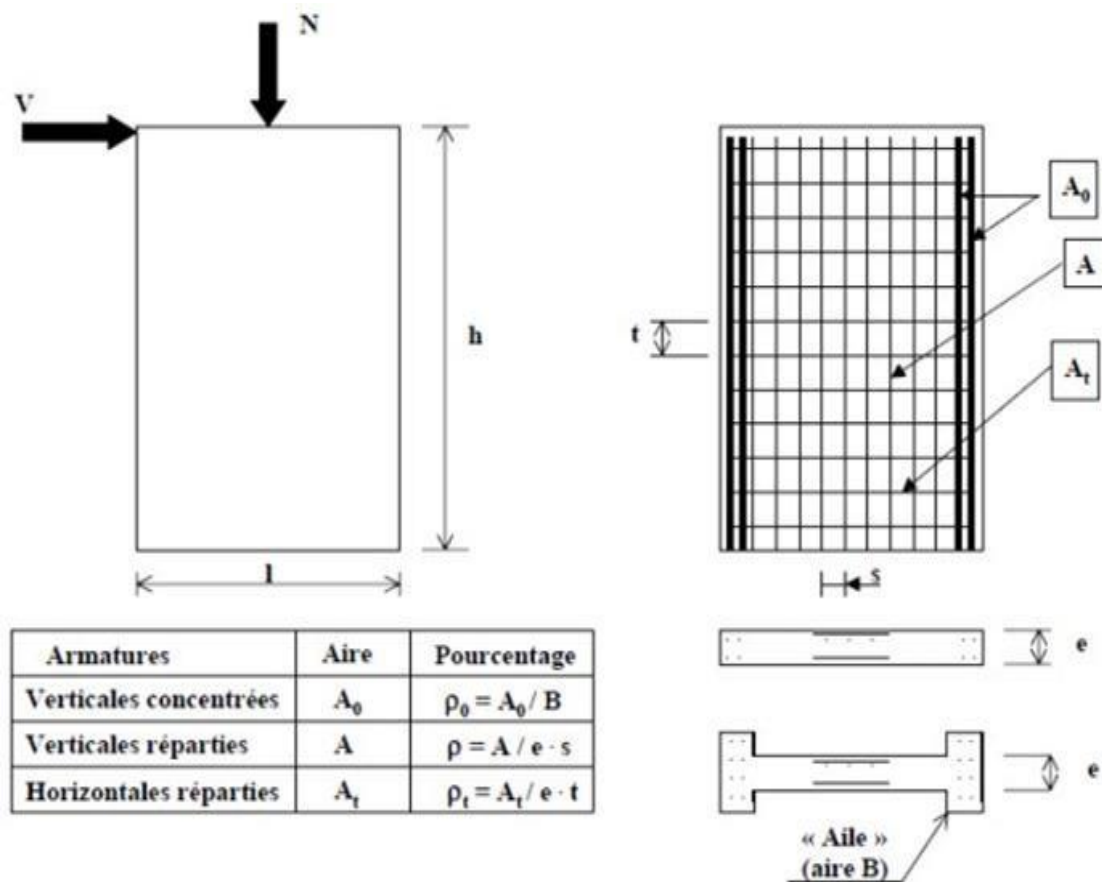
Schéma d'un voile plein et disposition du ferrailage.
